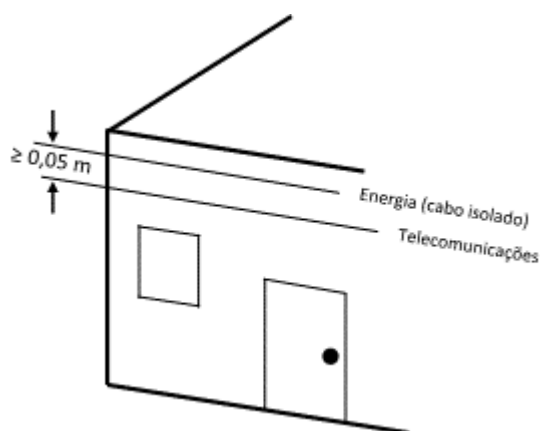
Traçados na vizinhança de linhas de BT em parede
